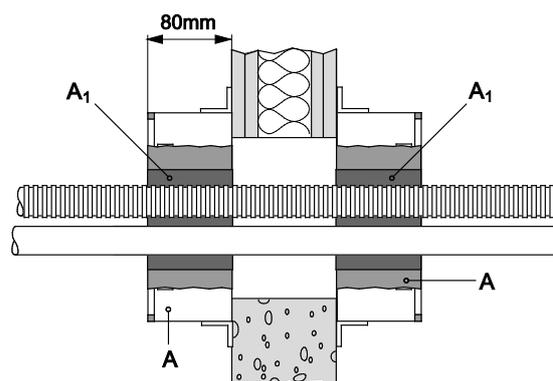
type de calfeutrement - des deux côtés + insert de mousse
